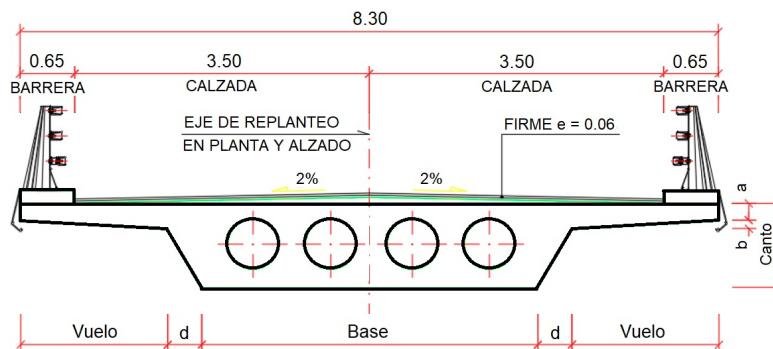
Sección transversal tipo del tablero de puente losa pretensado aligerado
